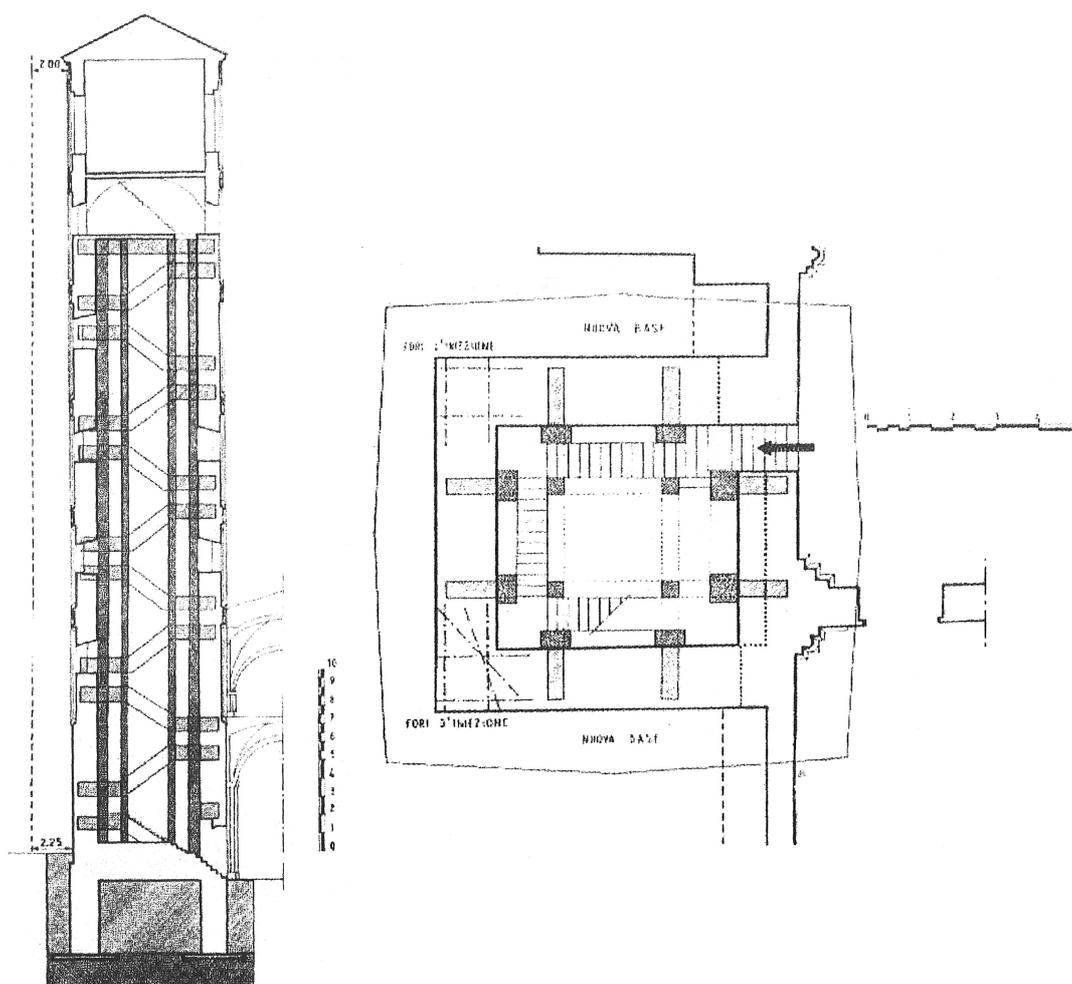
Campanile di Sant'Ambrogio: sezione e pianta del telaio interno in c.a. [3]
